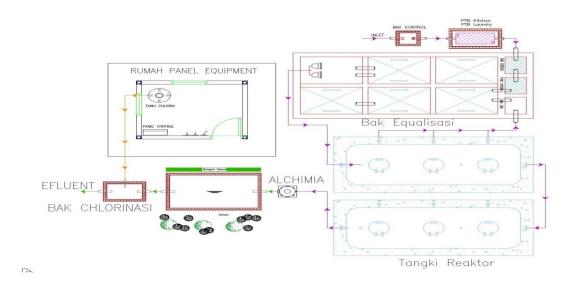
Denah Eksisting, Rencana Lokasi IPAL dan Permipaan
